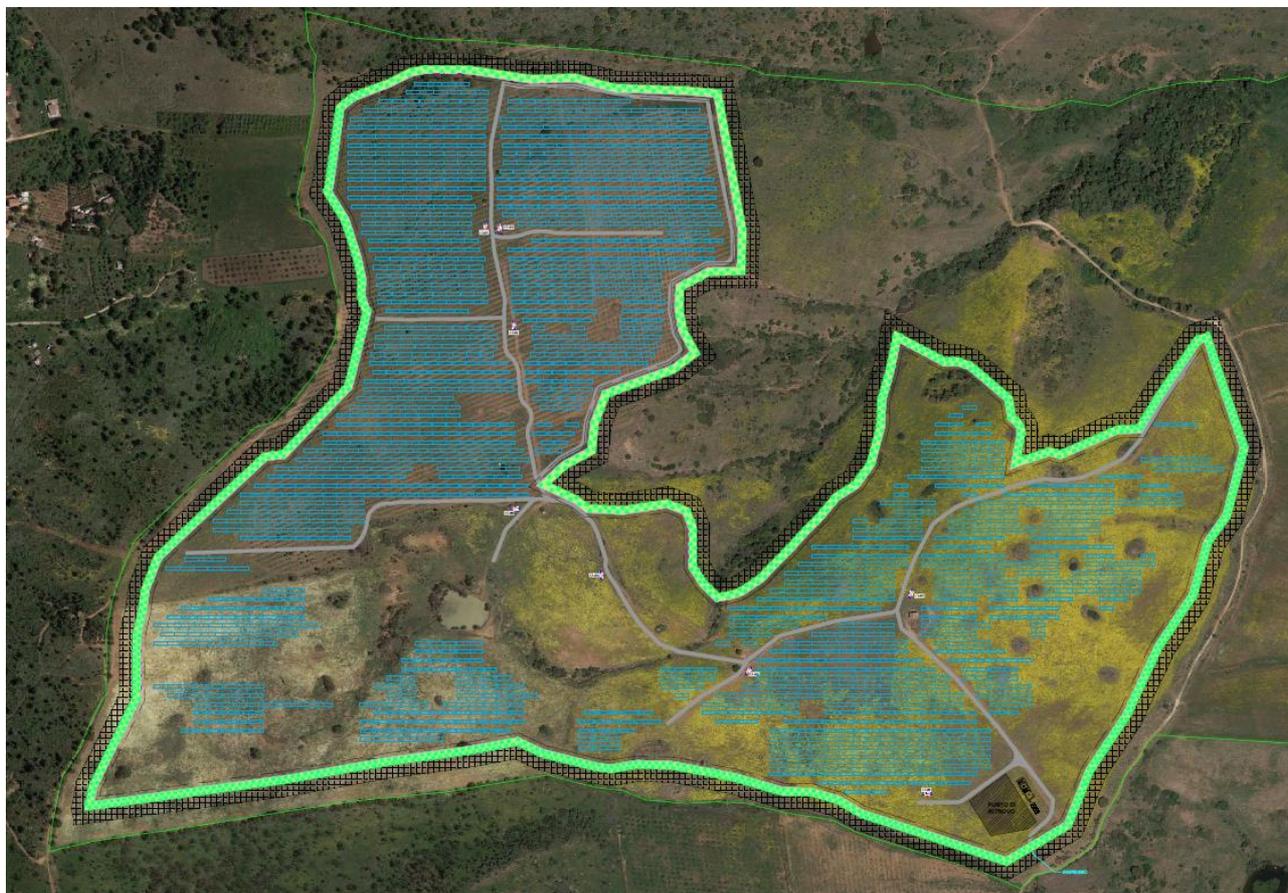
Stralcio Layout di Impianto (Progetto Definitivo)
